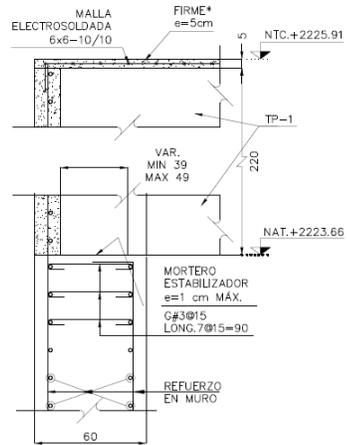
Detalle de apoyo de traves portantes en muro estructural.
